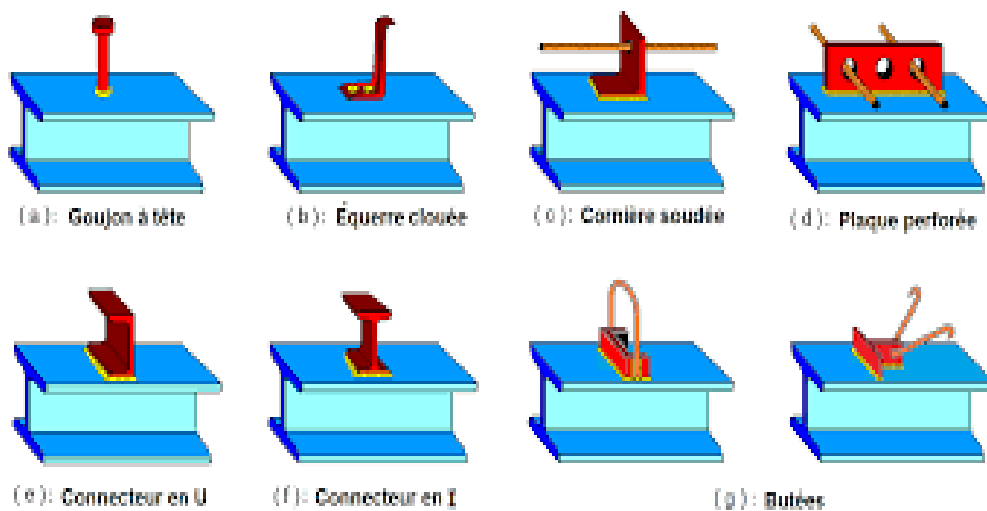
Types de connecteurs utilisés dans les poutres mixtes
